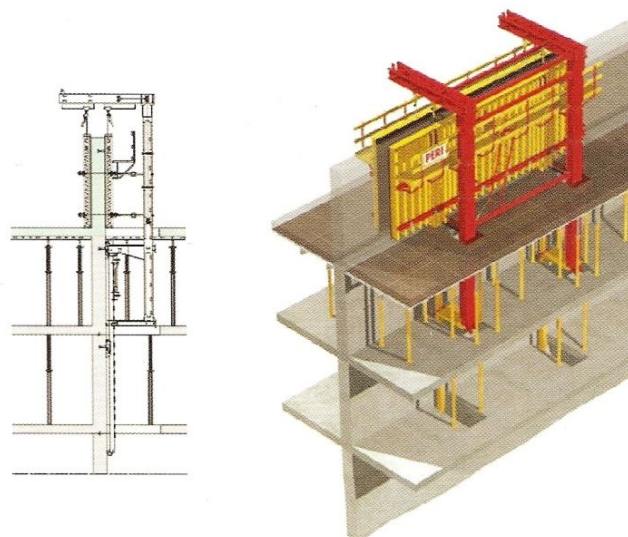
Execução monolítica com laje em ambos os lados do muro (Peri, 2008)
